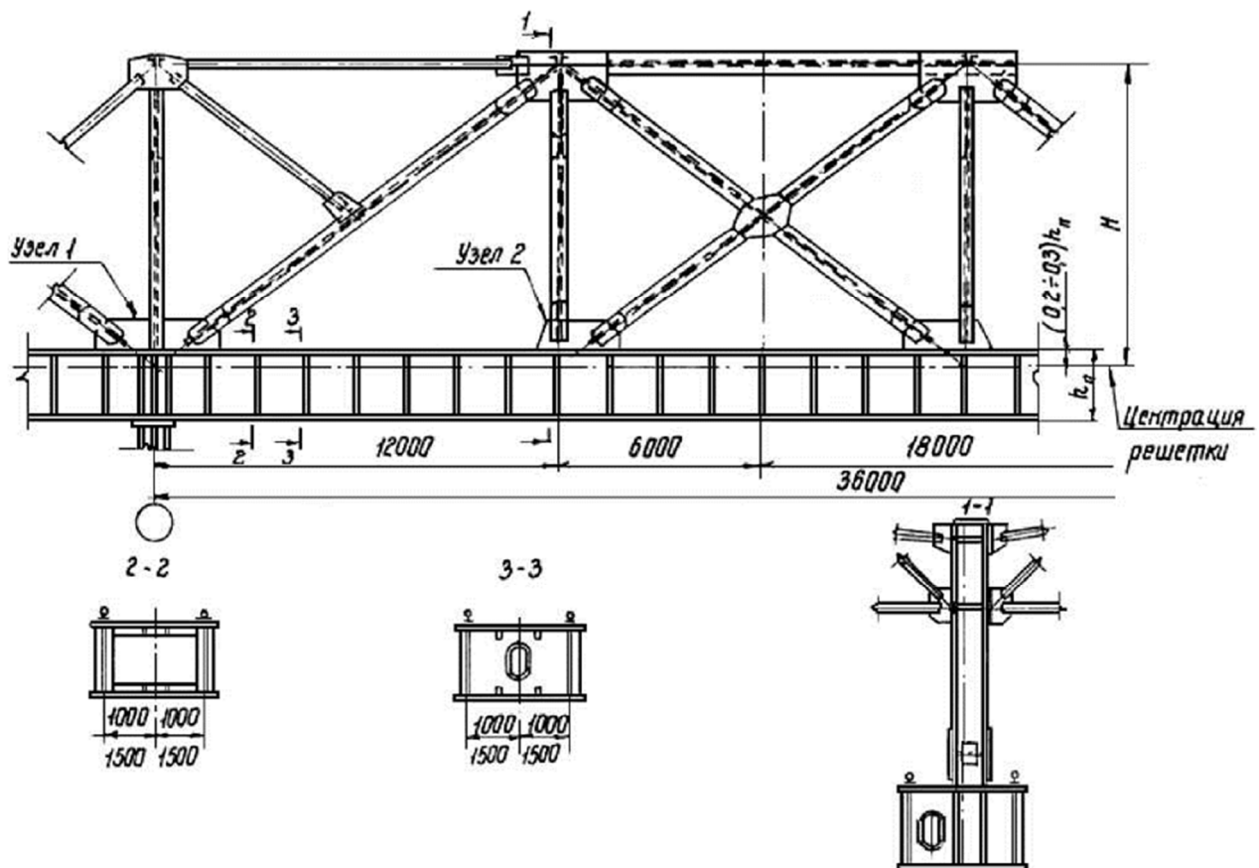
Продольная подкраново-подстропильная ферма пролётом 36 м с ездой по нижнему поясу
